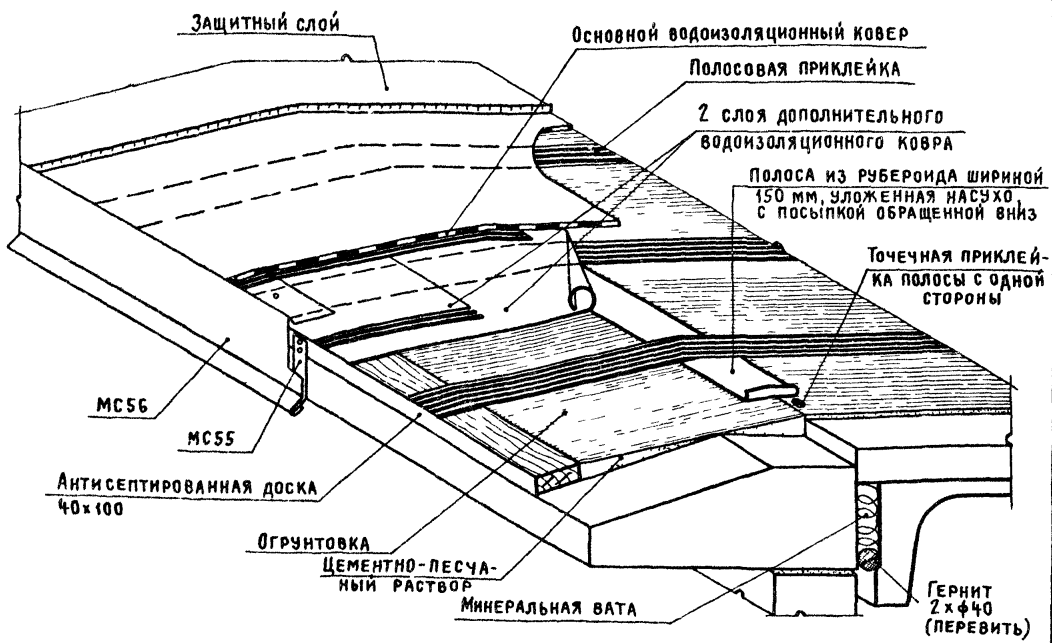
Карниз при уклоне кровли до 5% и шаге плит 6м (с выходом водяных паров)
